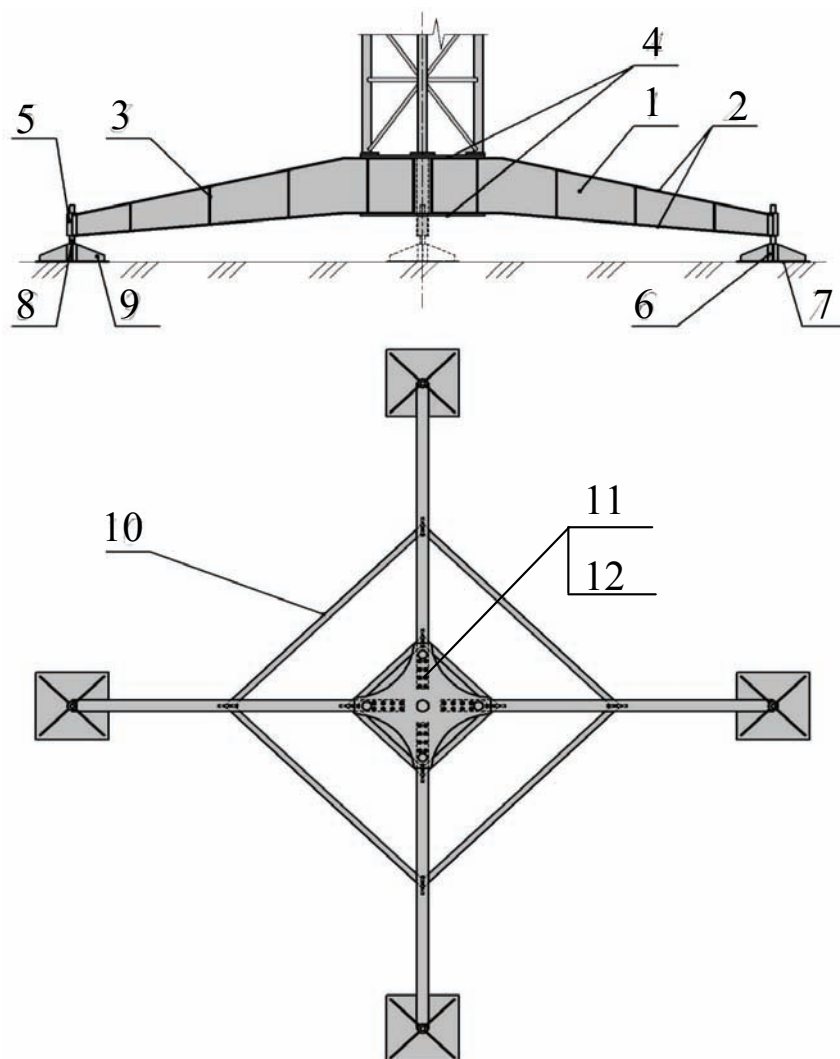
Конструктивне вирішення платформи у вигляді тригера на чотирьох флюгерах: 1 – стінка балки; 2 – полиці балки; 3 – ребра жорсткості; 4 – з’єднувальна діафрагма; 5 – втулка з різьбою; 6 – втулка із сферичною п’ятою; 7 – опорна пластина; 8 – гвинт; 9 – ребро; 10 – зв’язки; 11 – болт; 12 – гайка
